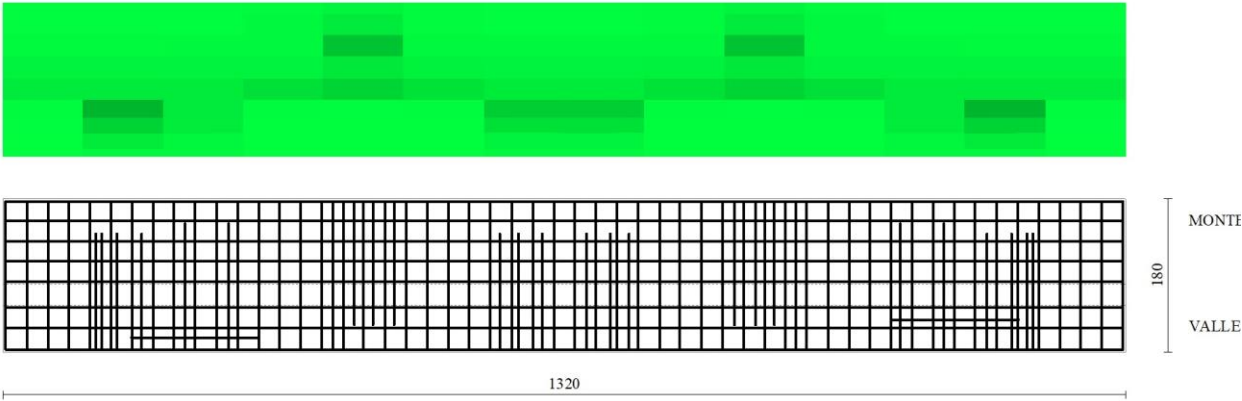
Piastra fondazione dir. Y (Inviluppo)
